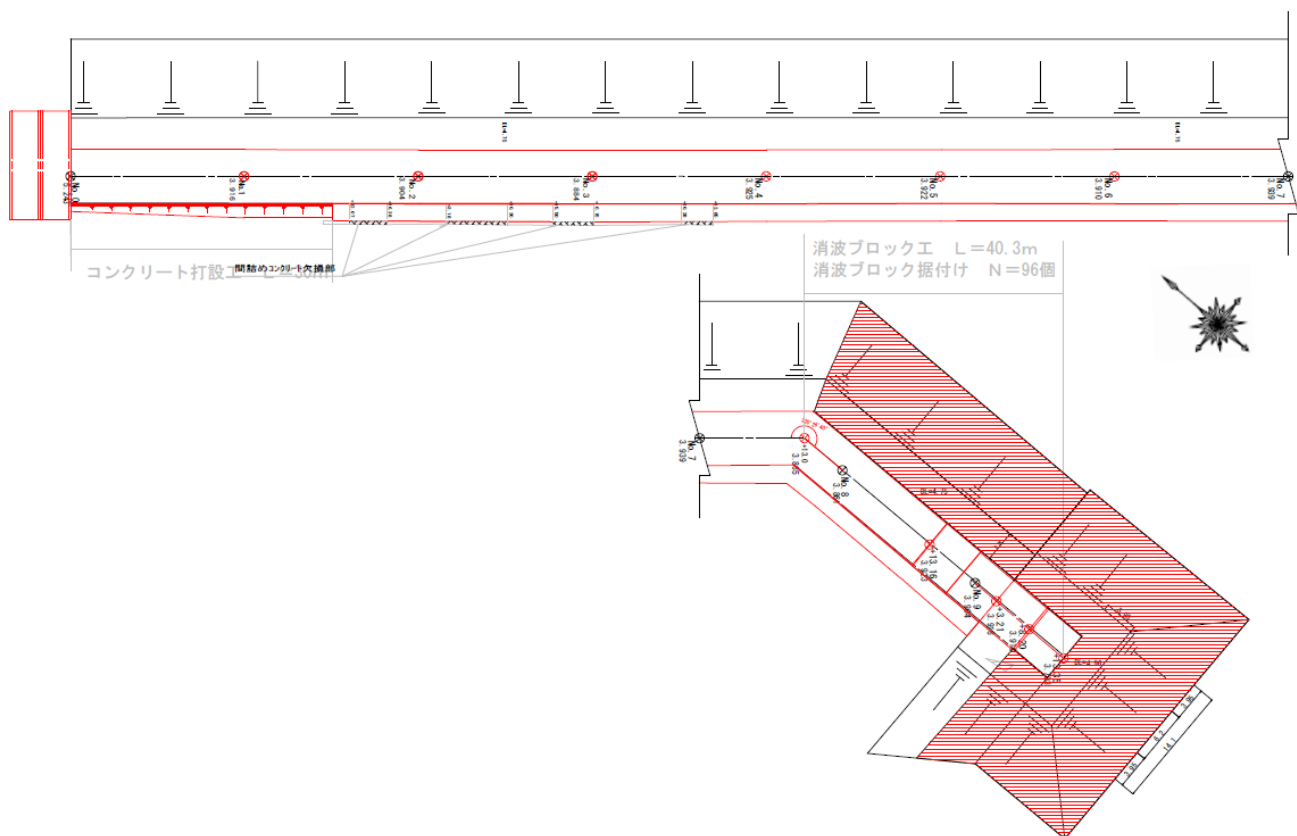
187 No. 2 鹿島港海岸突堤(日川)の平面図 (被災後)
